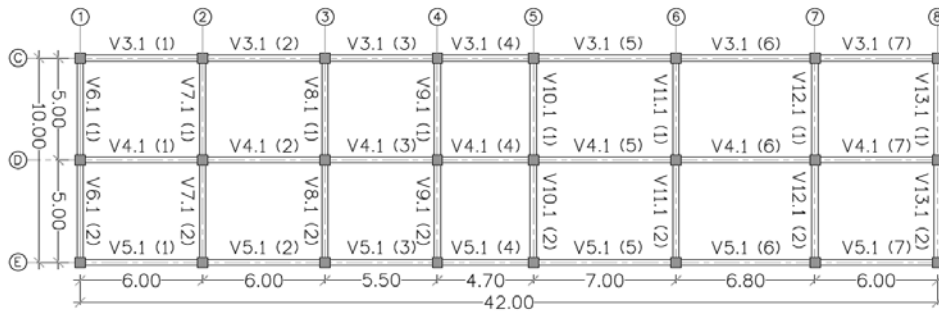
Planta de Identificação das Vigas do Piso 1
